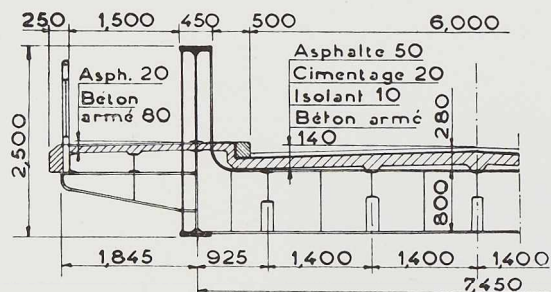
Demi-coupe transversale montrant la disposition adoptée pour le tablier.
